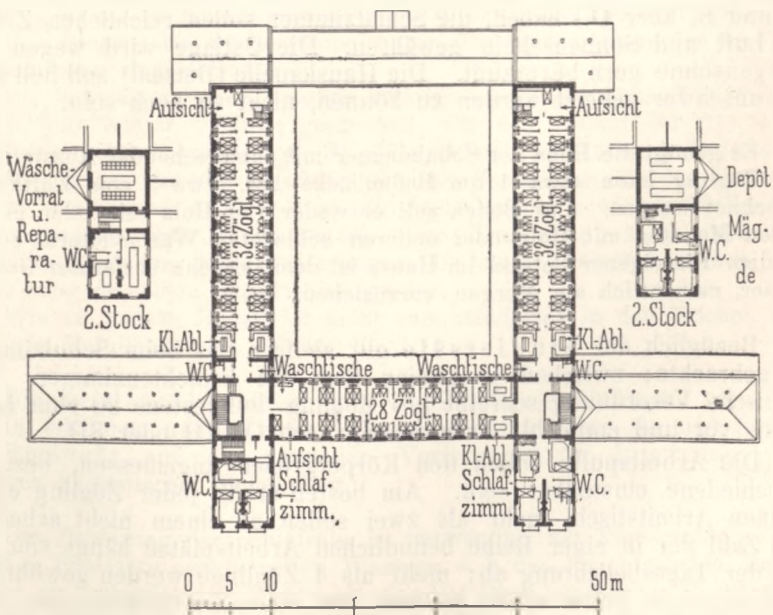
Grundriß des ersten und zweiten Stockwerks zu Fig. 302.
